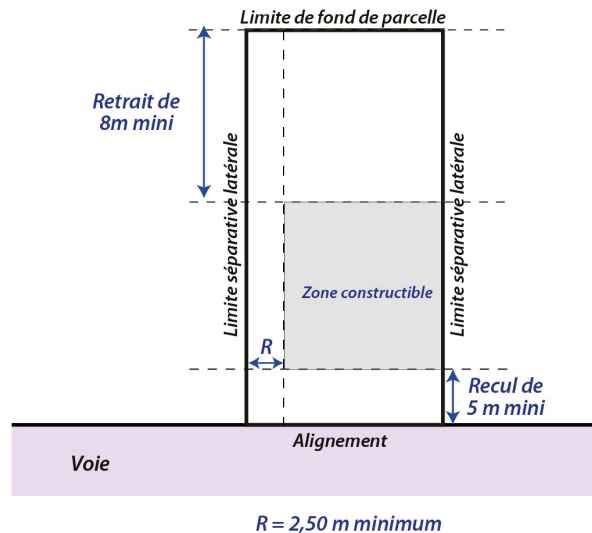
Règles de retrait des constructions applicables en 1Auh
